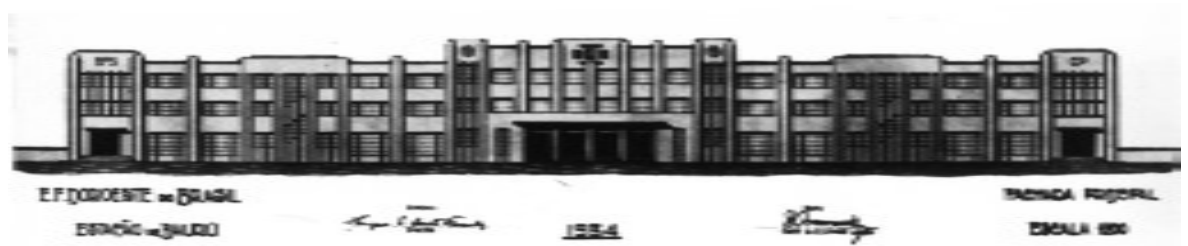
Desenho da fachada da Sede da Estação Ferroviária de Bauru em 1934.
